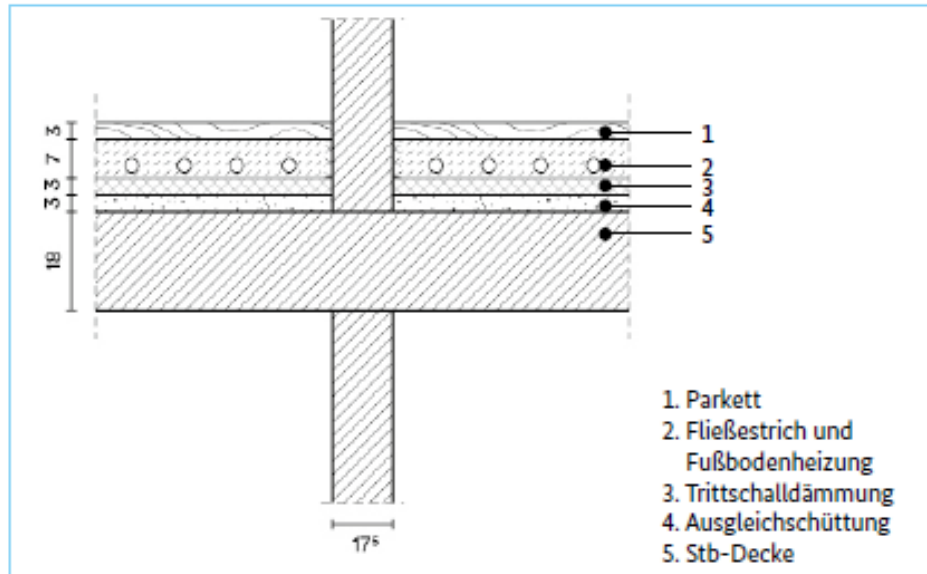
Herkömmliche Bauweise – Massivbau Geschossdecke
